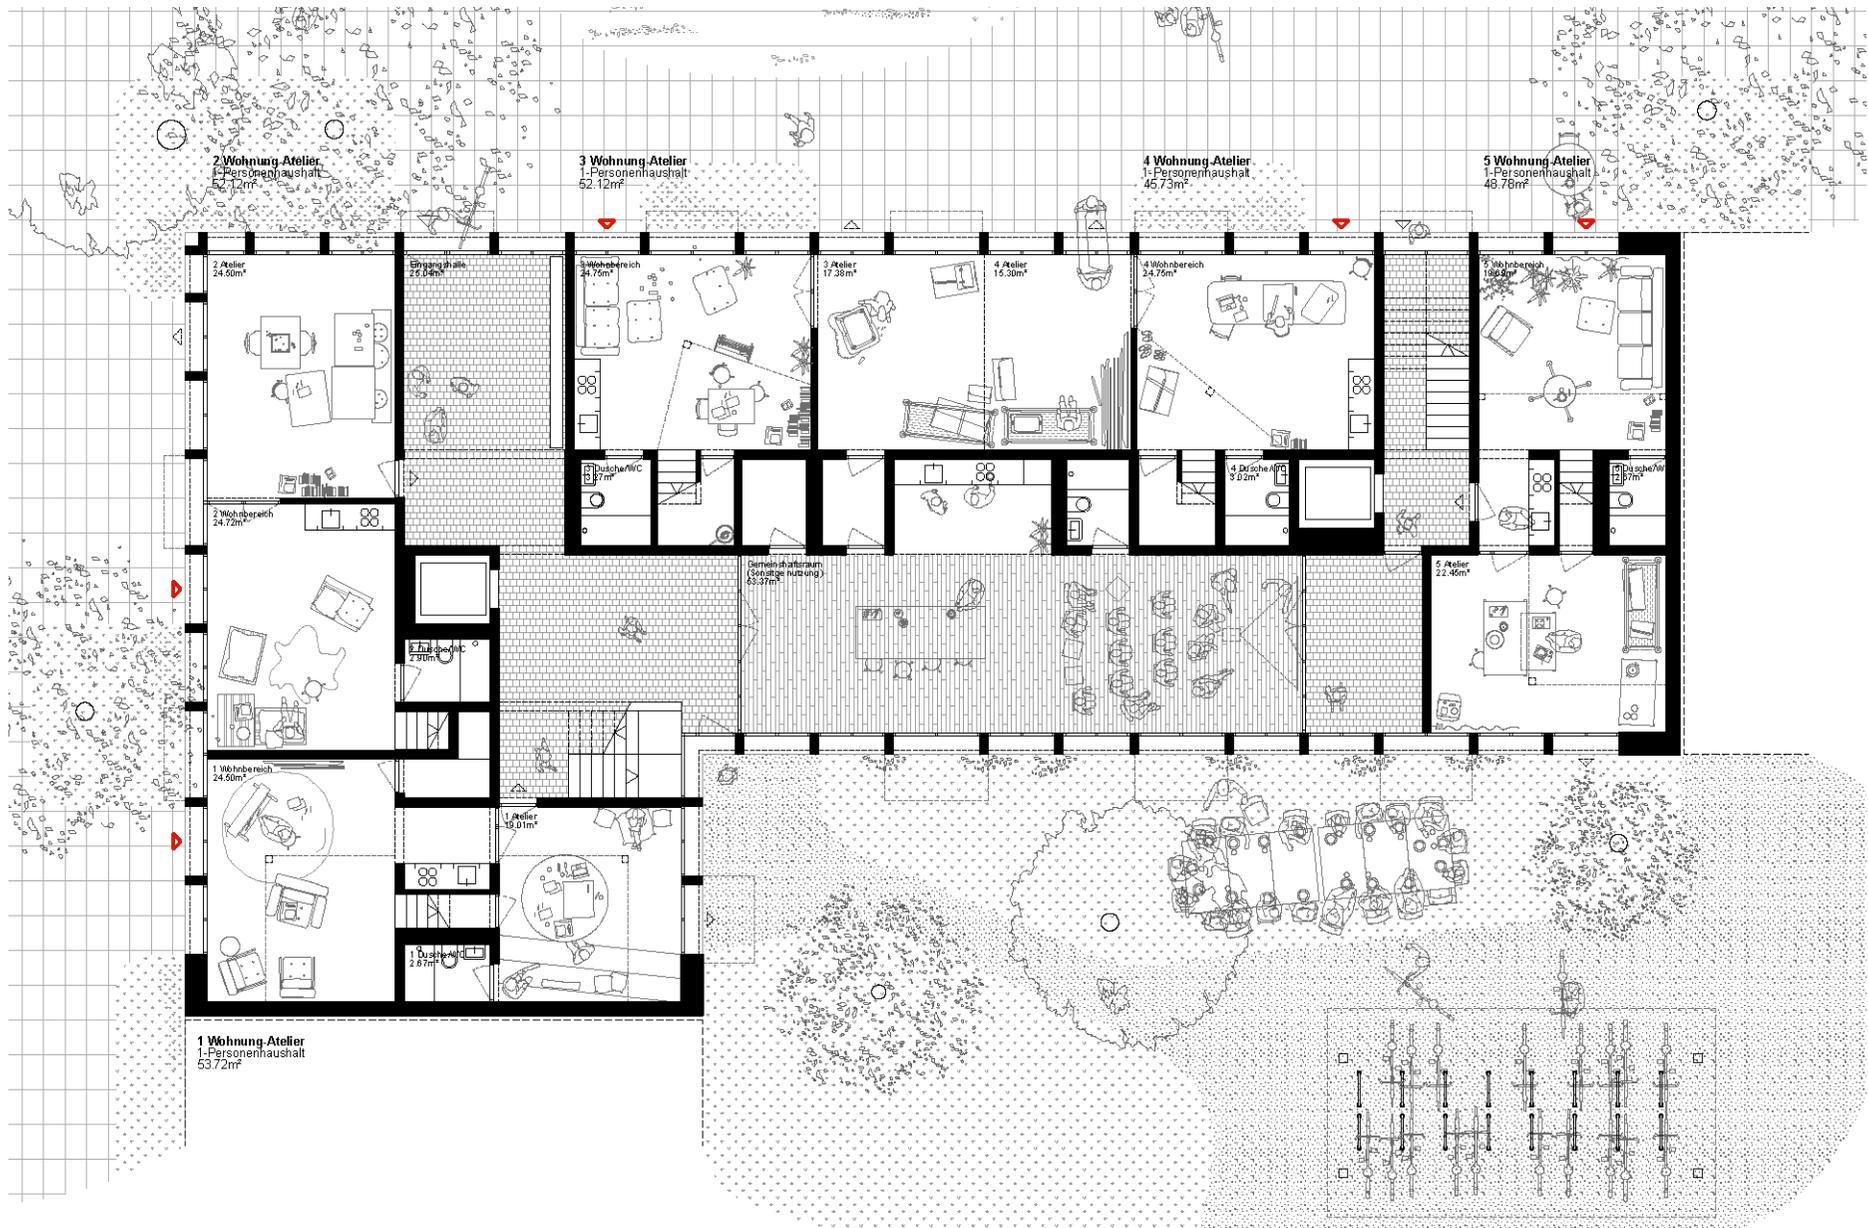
Erdgeschoss | M 1:175 | Lacol (Barcelona)
